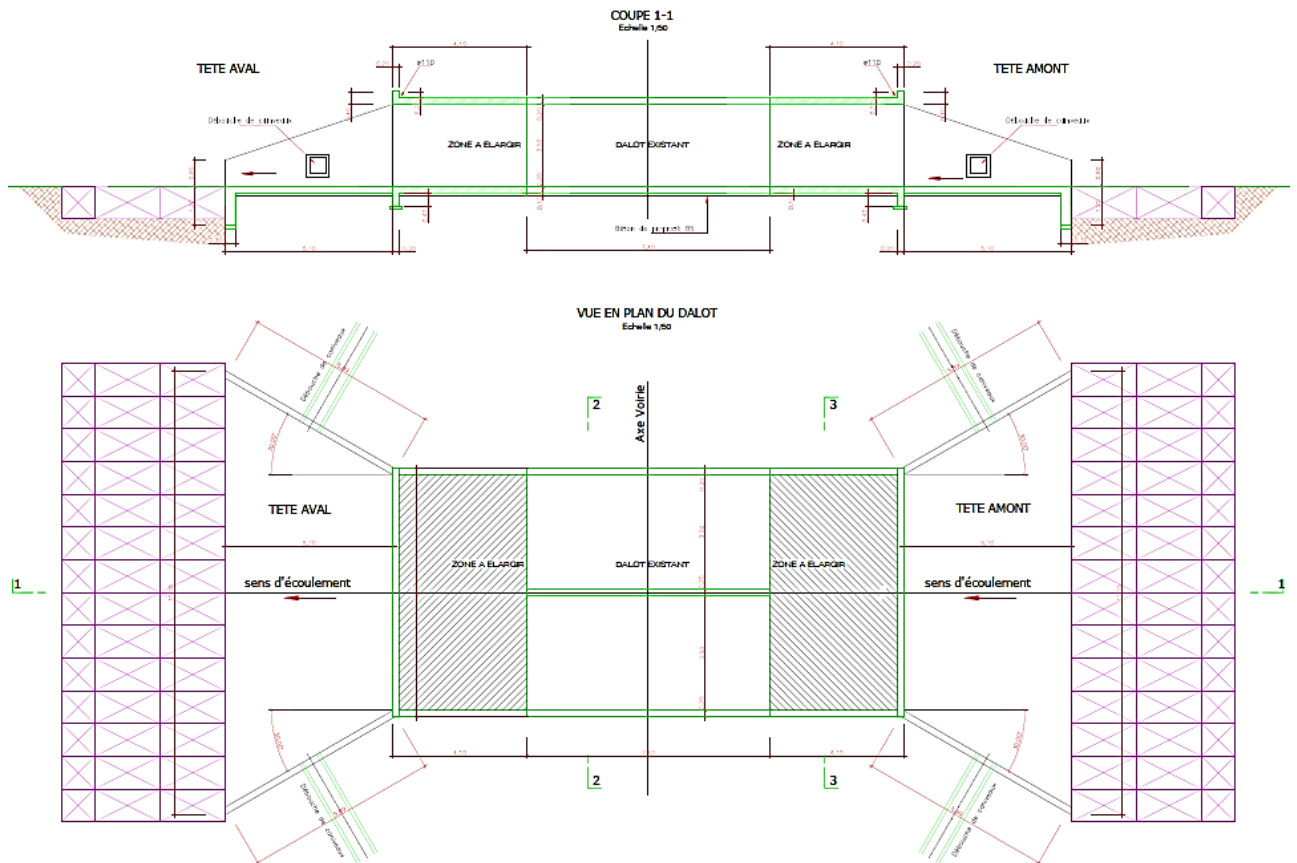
Elargissement du dalot « OH » située sur la voir N°3.
